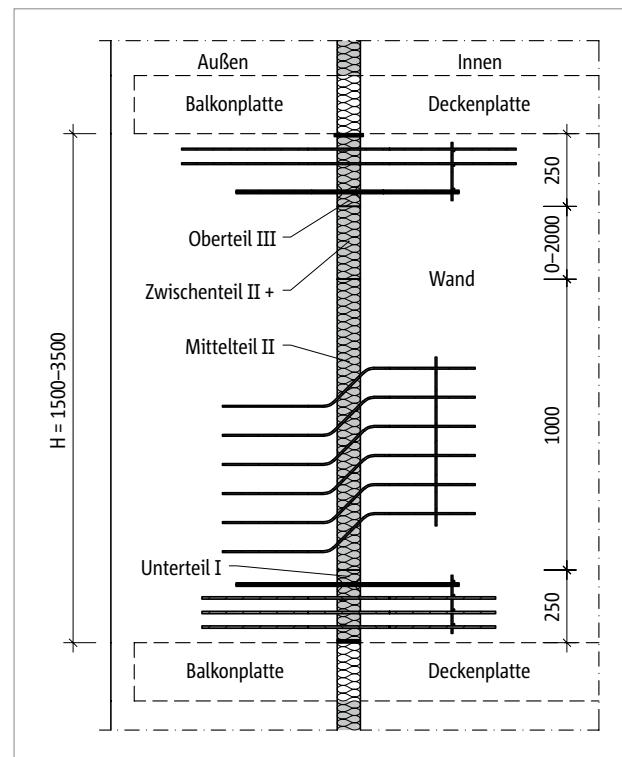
Schöck Isokorb® T Typ WL: Balkonkonstruktion mit wärmedämmten tragenden Wandscheiben
